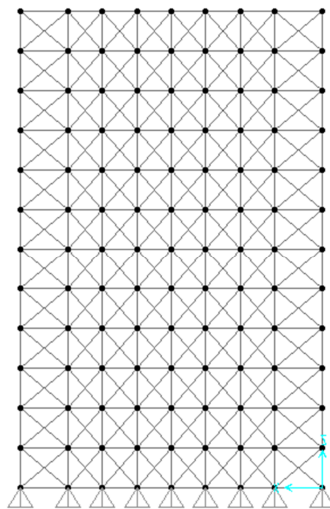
Configuração dos Planos de Contraventamento Vertical Com Elementos de Contraventamento Pequenos
